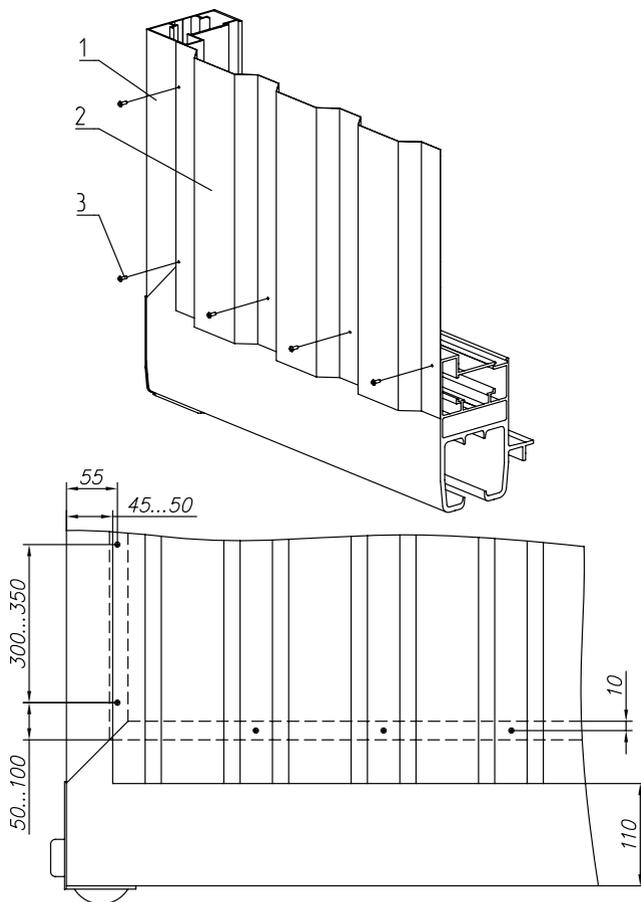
Установка заполнения из профилированного листа с накладным типом монтажа
